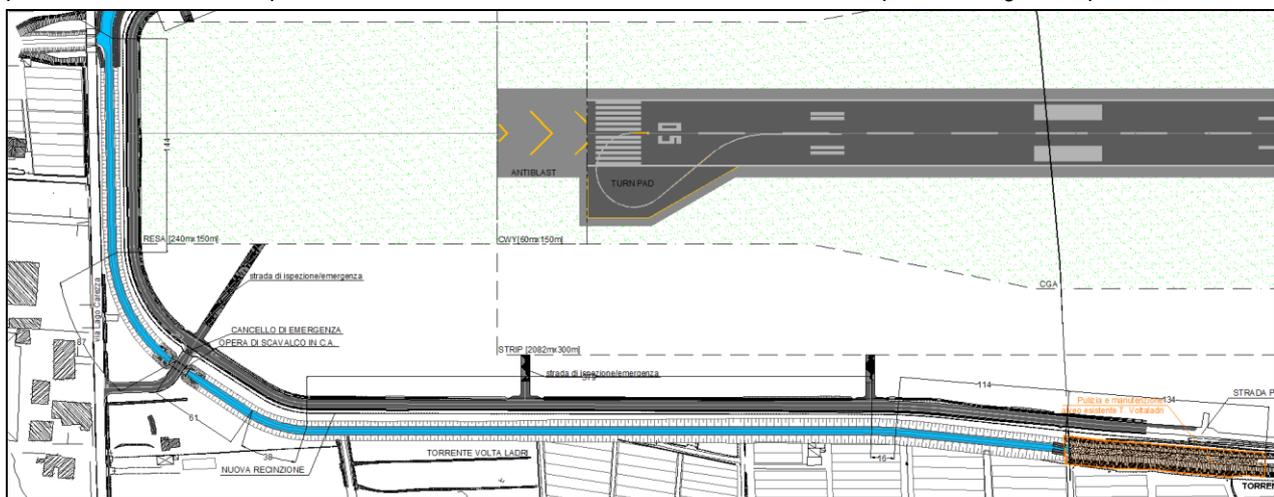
Andamento Planimetrico di progetto del Torrente Voltladri
